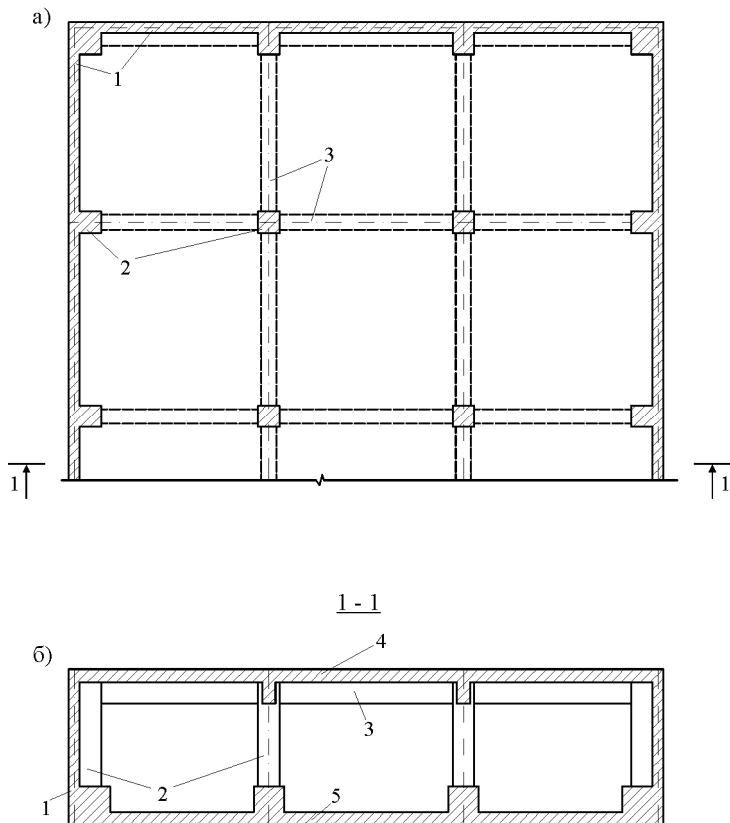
Монолитное здание пункта управления предприятия с взрывоопасным производством: *a* – схема расположения колонн, ригелей и стен в плане здания (фрагмент); *б* – поперечный разрез; 1 – стены; 2 – колонны; 3 – продольный и поперечный ригели; 4 – плита покрытия; 5 – фундаментная плита
